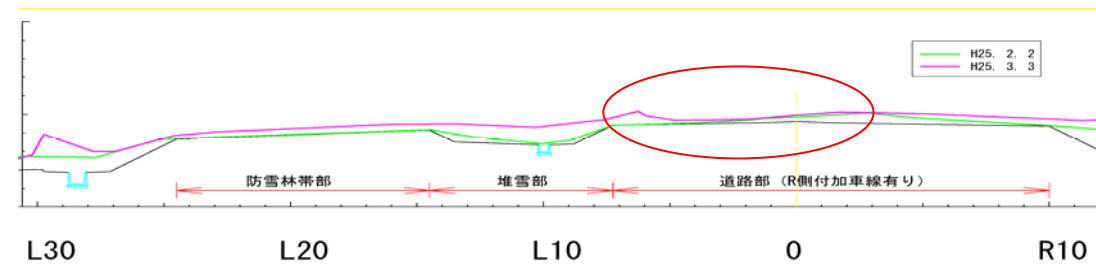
積雪横断面図 (防雪柵未設置区間 SP3760)
